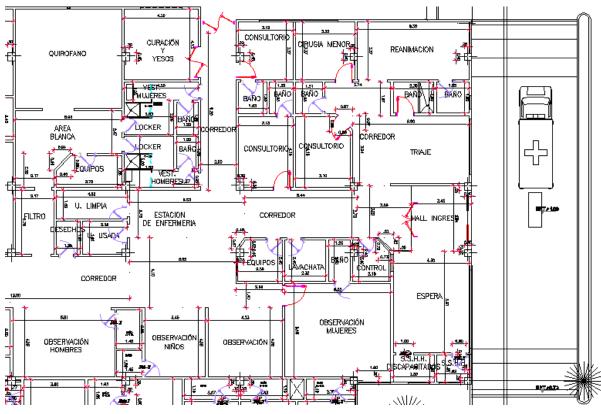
Plano Arquitectónico de la distribución de las áreas de emergencias del IESS Hospital de Babahoyo.
